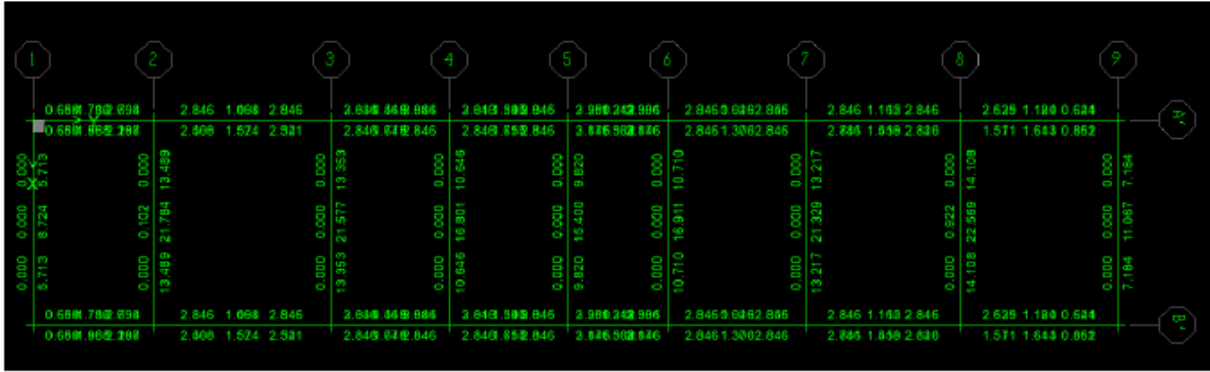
Área de acero de refuerzo en vigas Primer Techo (cm²)
